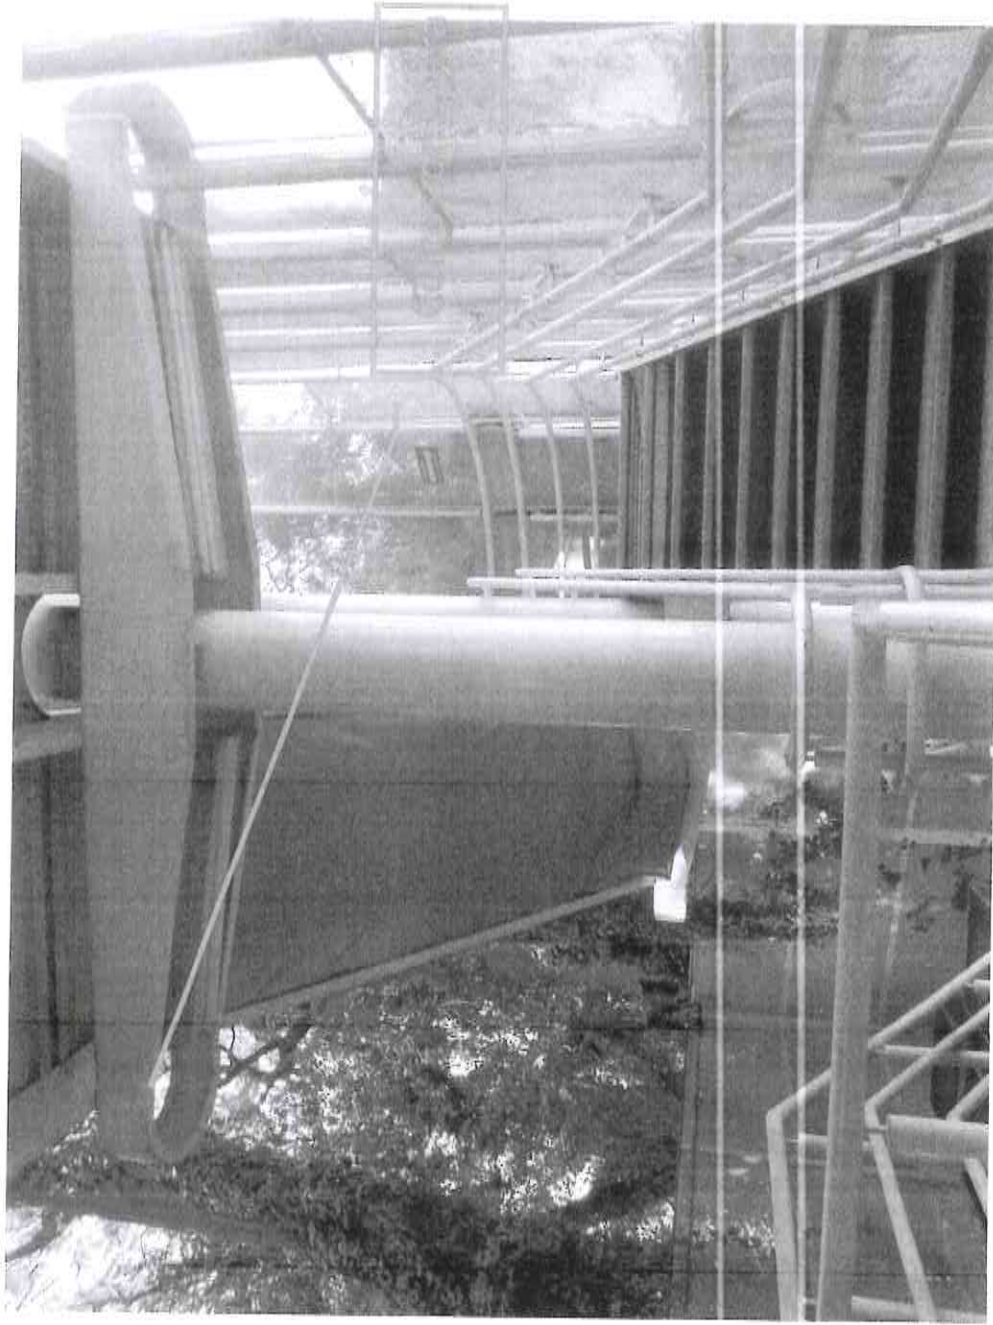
Estructura de desplante de escalera de emergencia sin daño estructural
